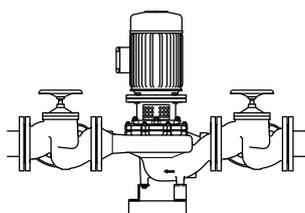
Struttura verticale / Fissaggio con 3 piedi di appoggio angolari (acciaio 37, accessori), grandezze costruttive da 032-032-160 a 100-100-125
